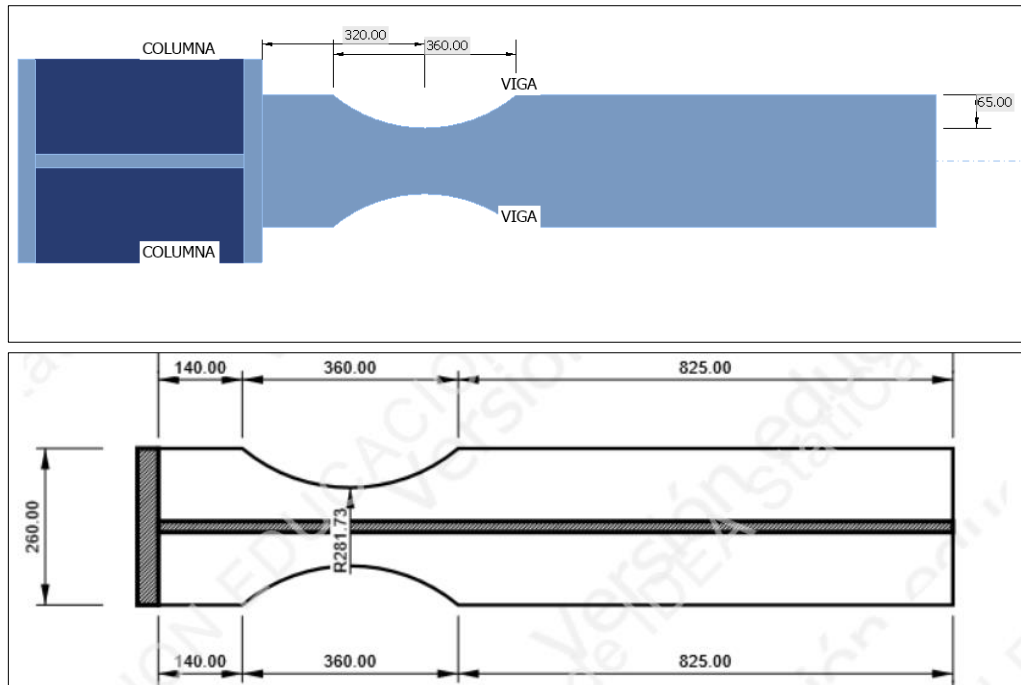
Dimensiones del recorte de las alas para la sección reducida de la viga
